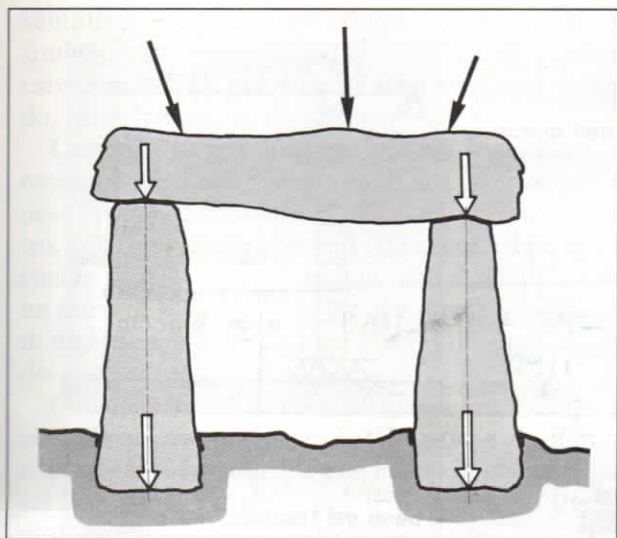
Esempio di sistema strutturale semplice: architrave su piedritti (trilite).
